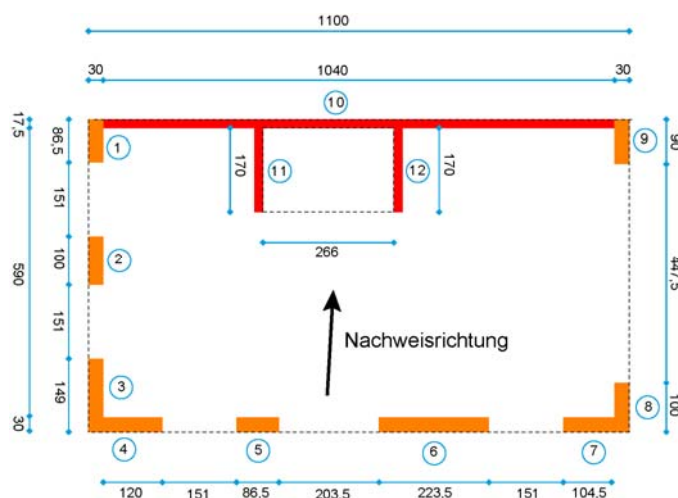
Doppelhaushälfte; Grundriss des Erdgeschosses
